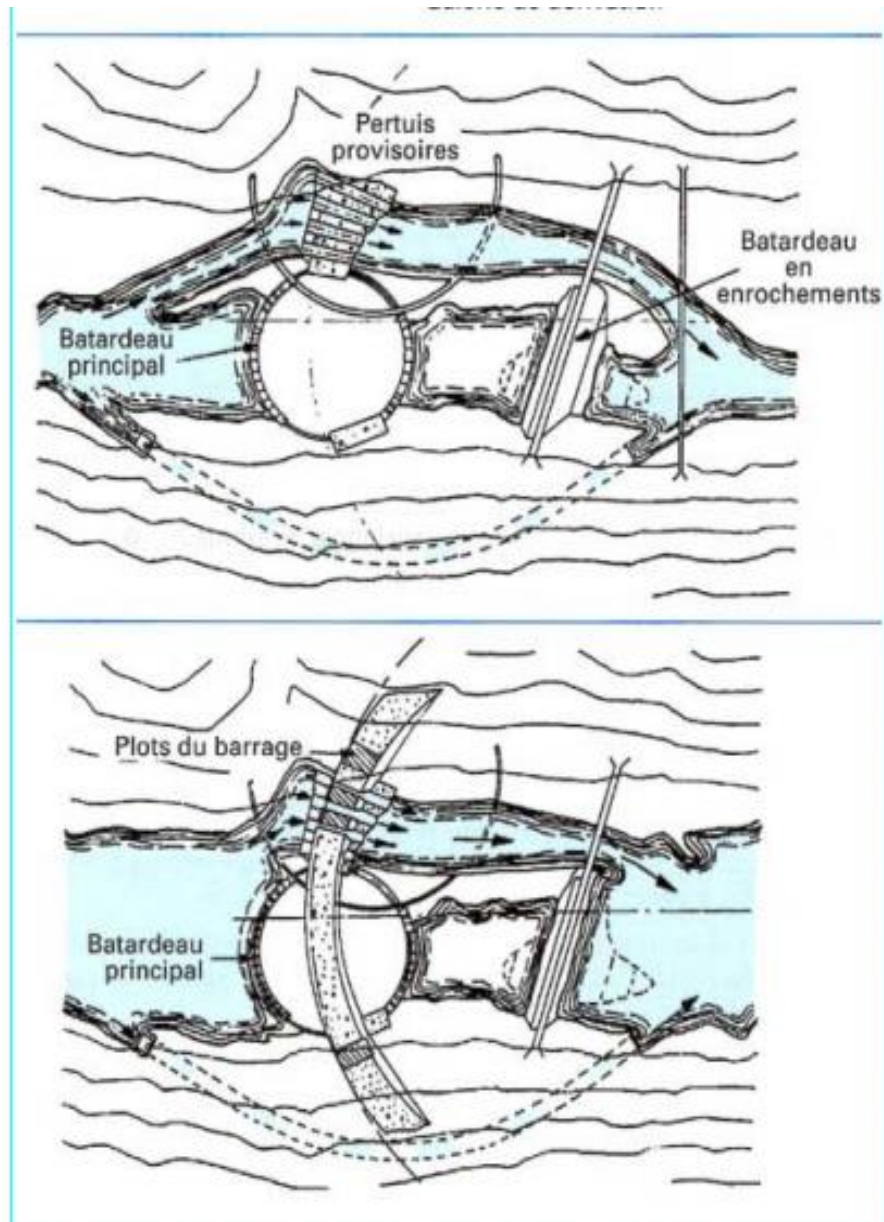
Batardeaux du chantier du barrage de Kariba (Zambie-Zimbabwe) (d'après Technique des travaux, janvier 1962)
